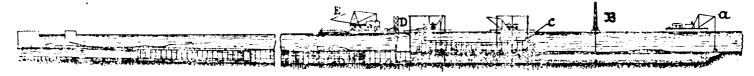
Tunnel sotto il Detroit River. Schema dei lavori. (A Draga; B Battipalo; C Cassoni d'aria; D Tramoggia per gettate di calcestruzzo; E Impastatrice).
